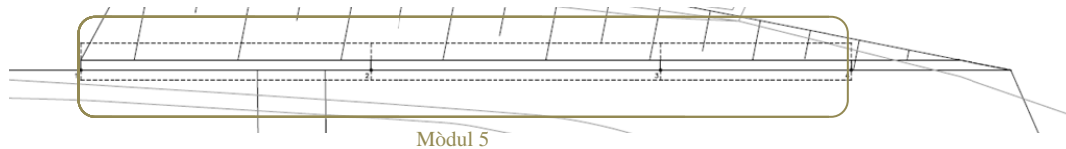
Plànol núm.18.1 full 4 Mur 3 planta.
